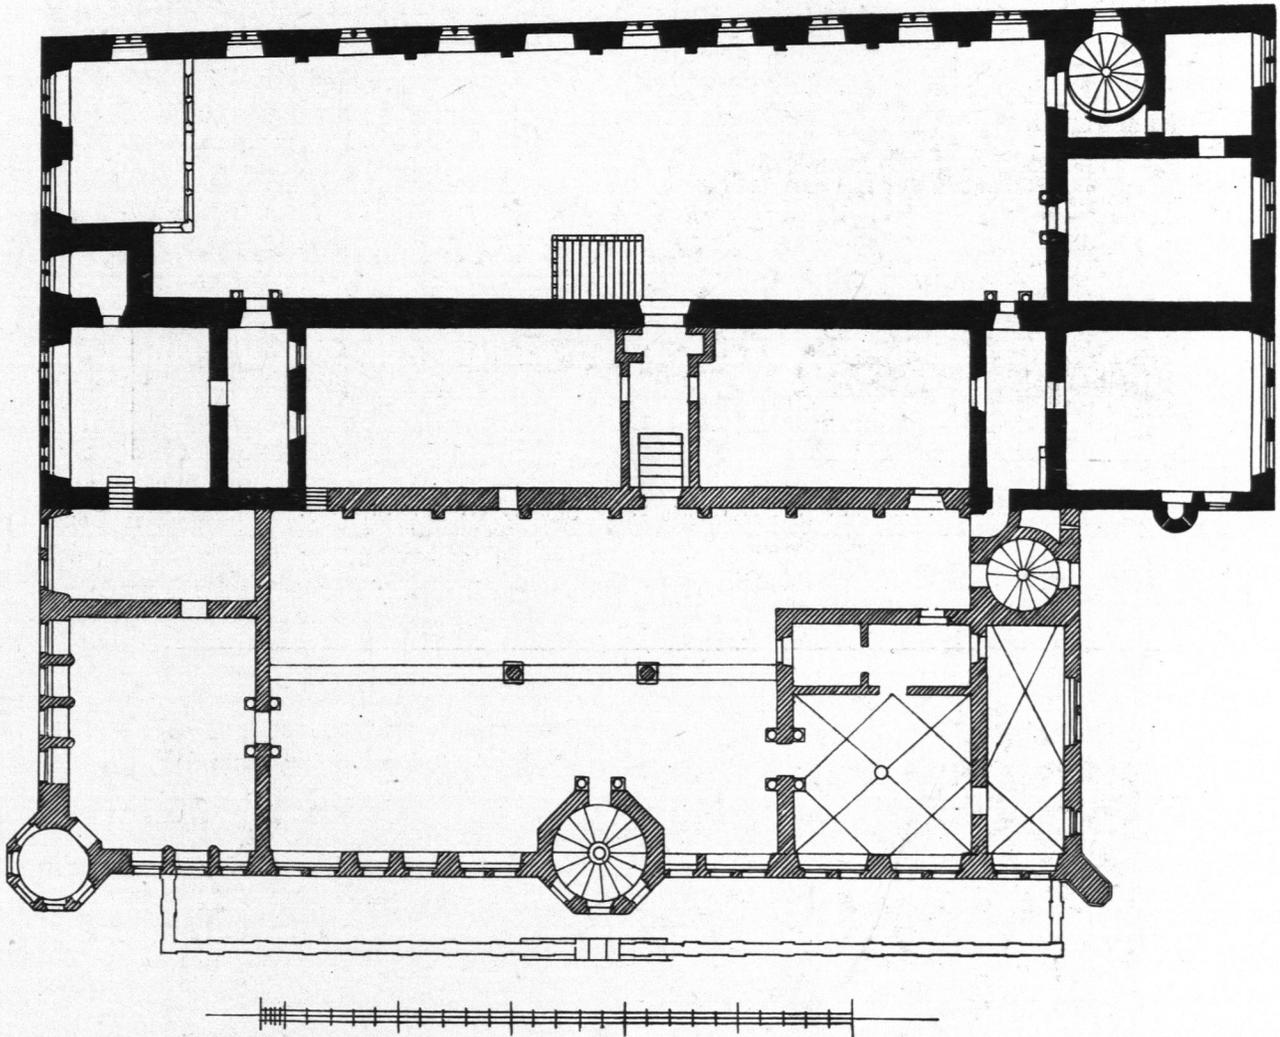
Rathaus zu Rothenburg o. T. Grundriß. Nach Bäumer, Aufnahmen der Stuttgarter Architektenschule.
